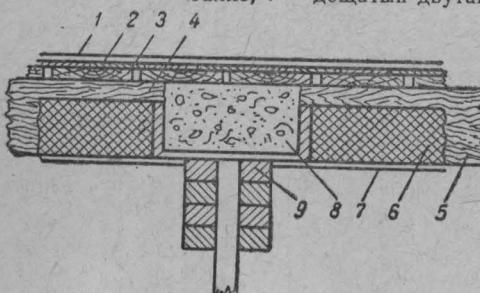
Противопожарная разделка в толще бесчердачных покрытий:
